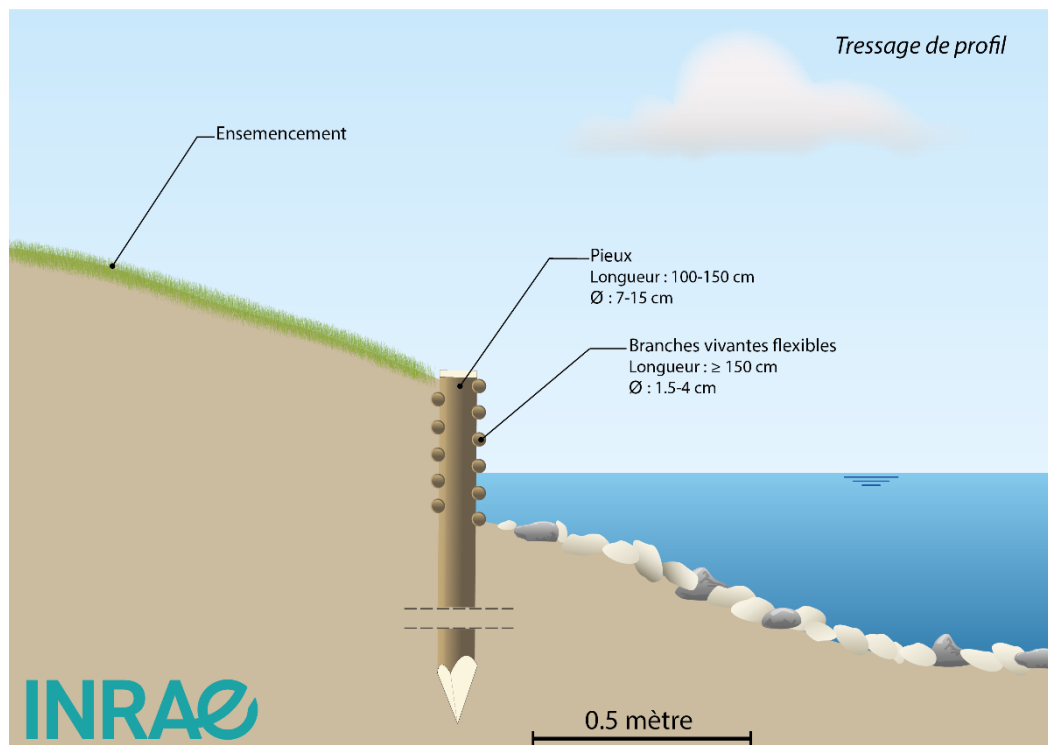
Profil en vue transversale d'un tressage en pied de berge.
